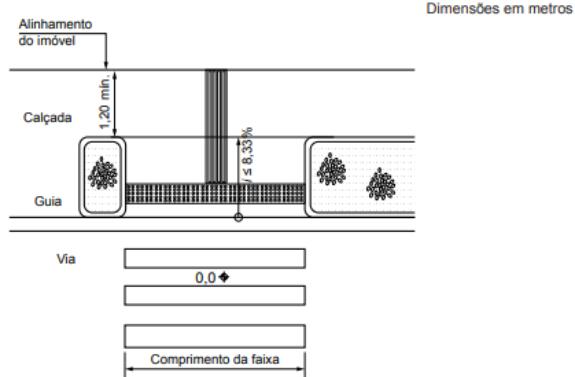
Rebaixamentos de calçada entre canteiros – Vista superior
